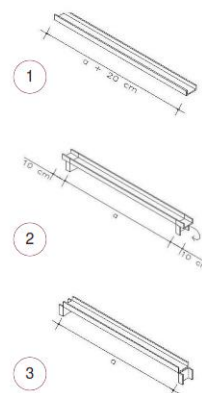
, Continuidad de un segundo piso. (Fuente: propia del autor)
